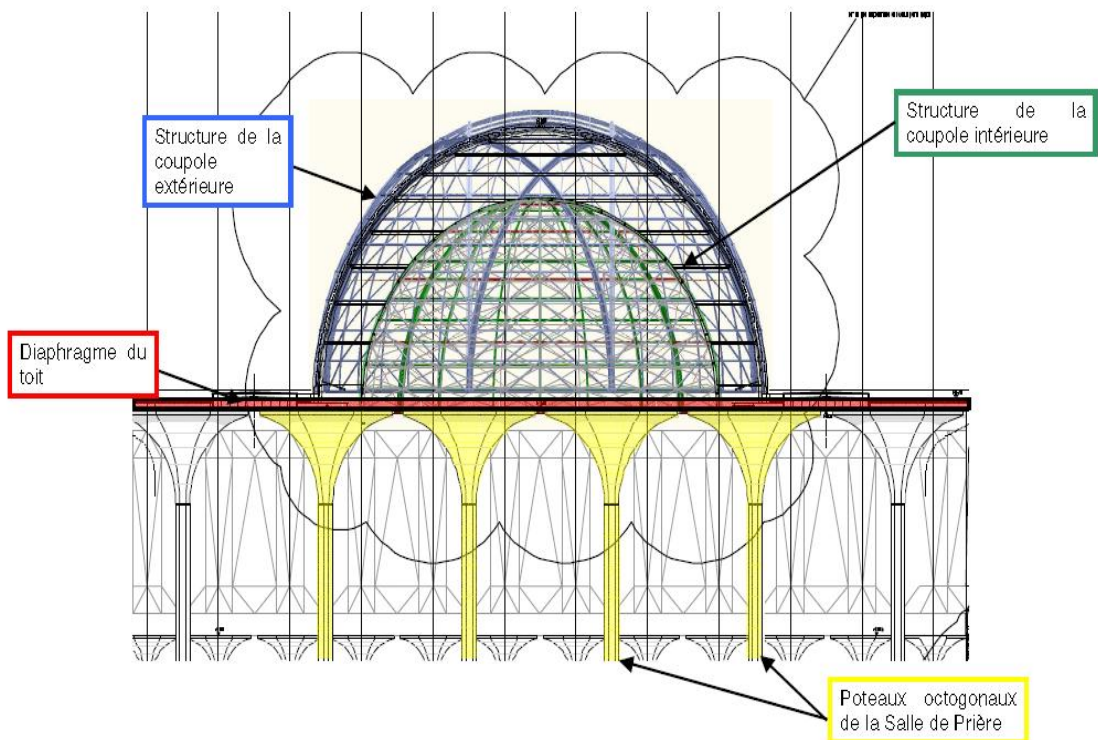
coupe de la structure porteuse de la coupole
